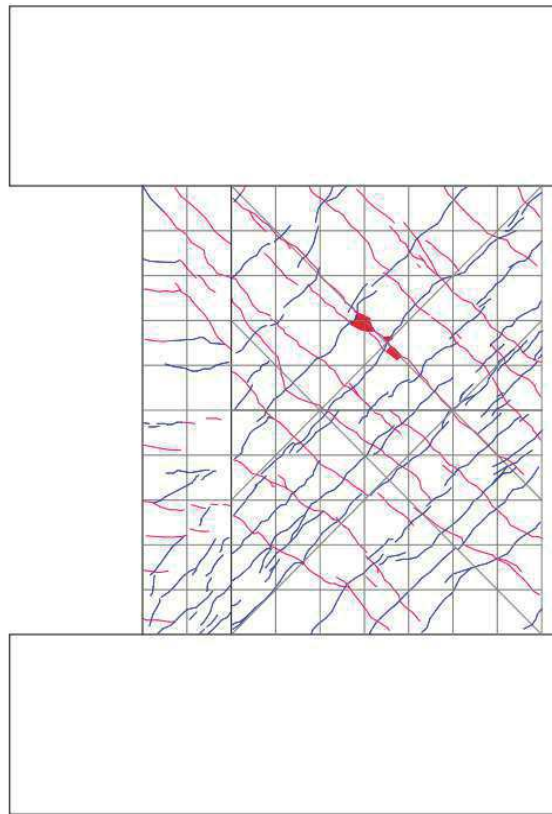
試験体 S-06-DII 6/1000rad. ひび割れ図
